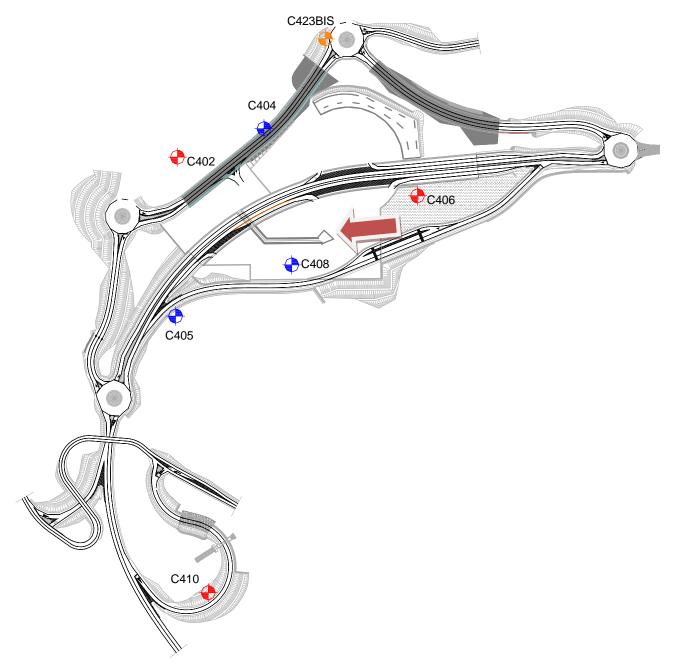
Stralcio planimetrico con ubicazione delle opere e dei sondaggi
